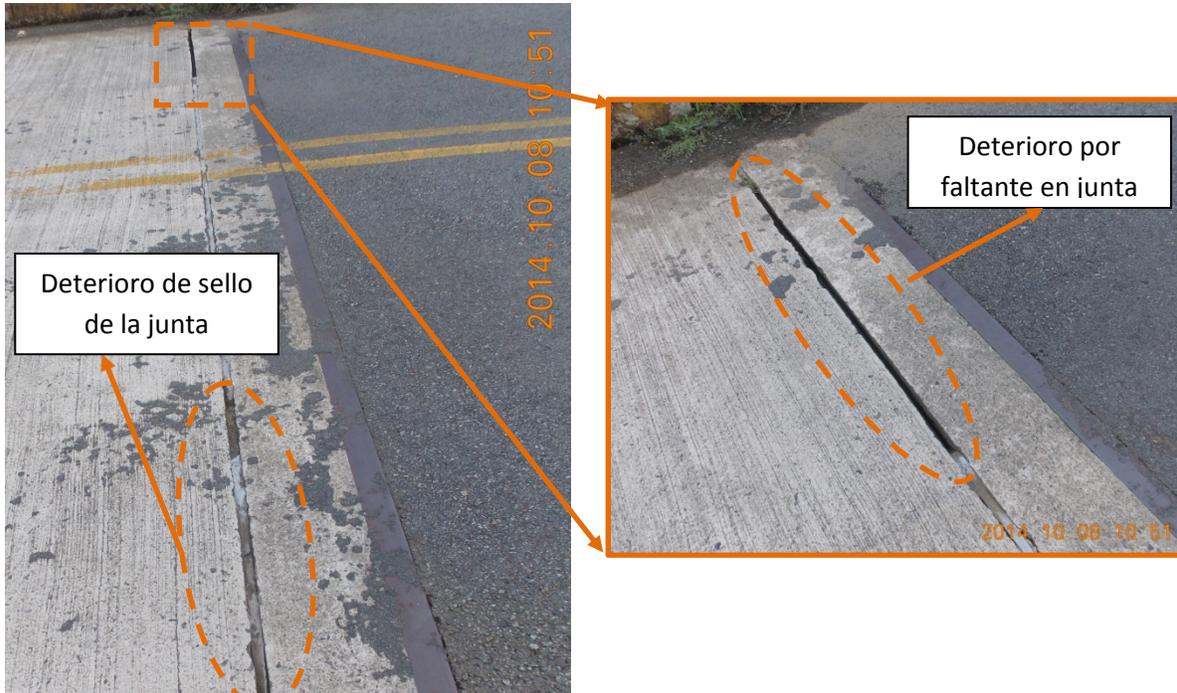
Detalles de deterioro en las juntas expansión en el acceso 2.
